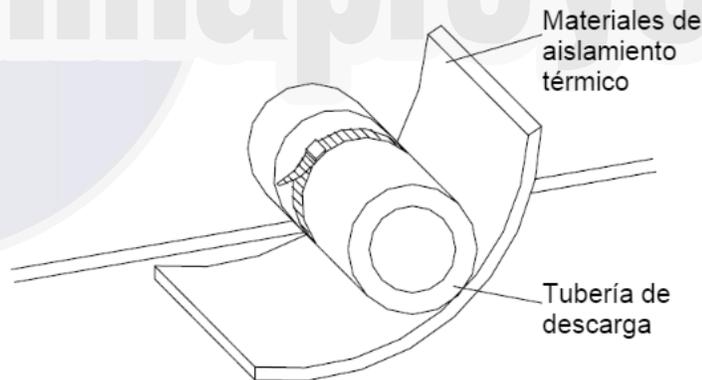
6 Aislamiento Térmico de la Tubería de Descarga
